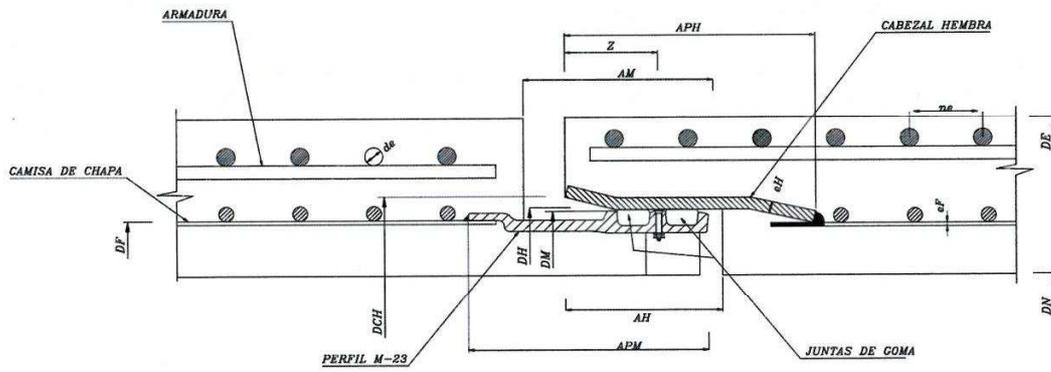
Junta elástica doble en tubería de hormigón armado con camisa de chapa.
